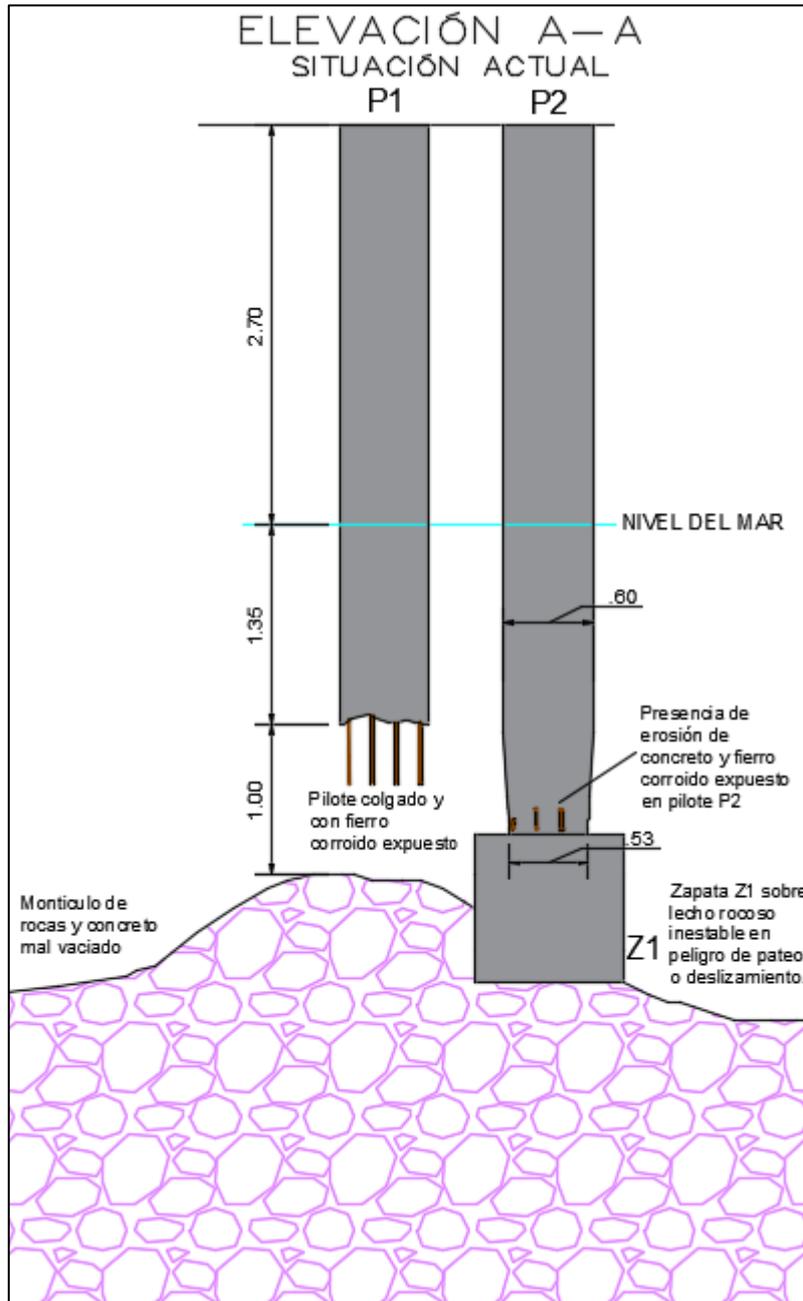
Elevación A –A donde muestra la situación actual de los pilotes P1 y P2
